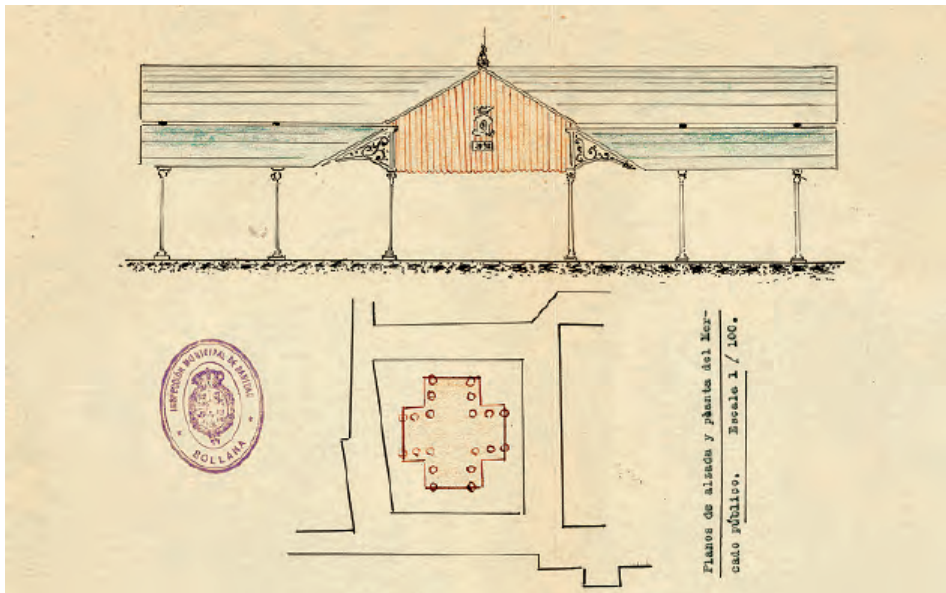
Ayuntamiento de Sollana, Plano de alzado y planta del mercado público, 1928. A.D.P.V.
